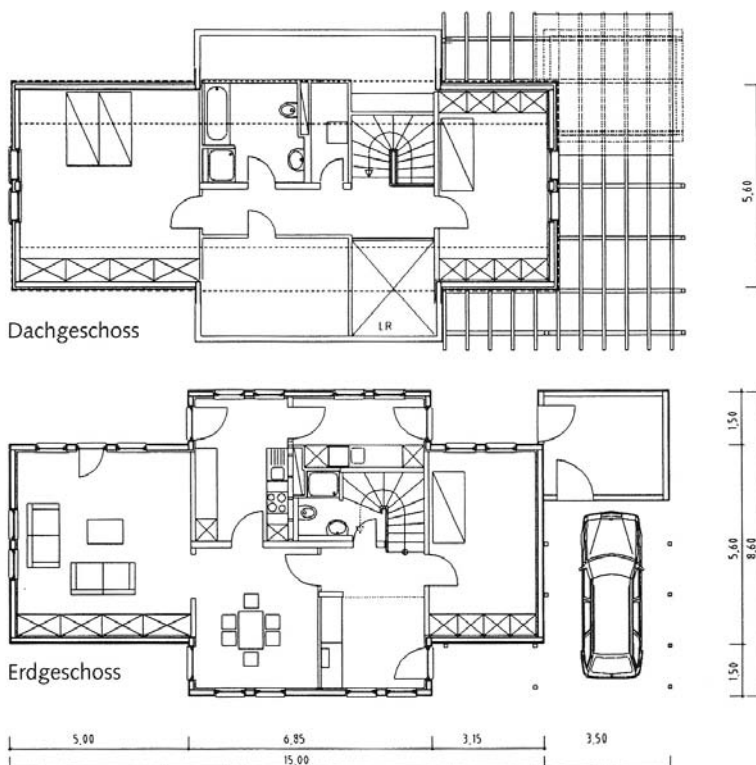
Grundrisse des Holzhauses Wohnfläche
